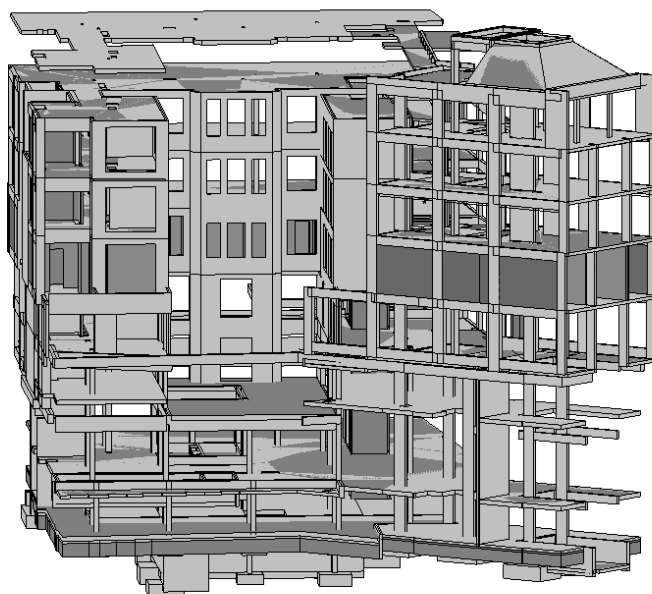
Modelo inicial Revit, obra Aliados Plaza Hotel
